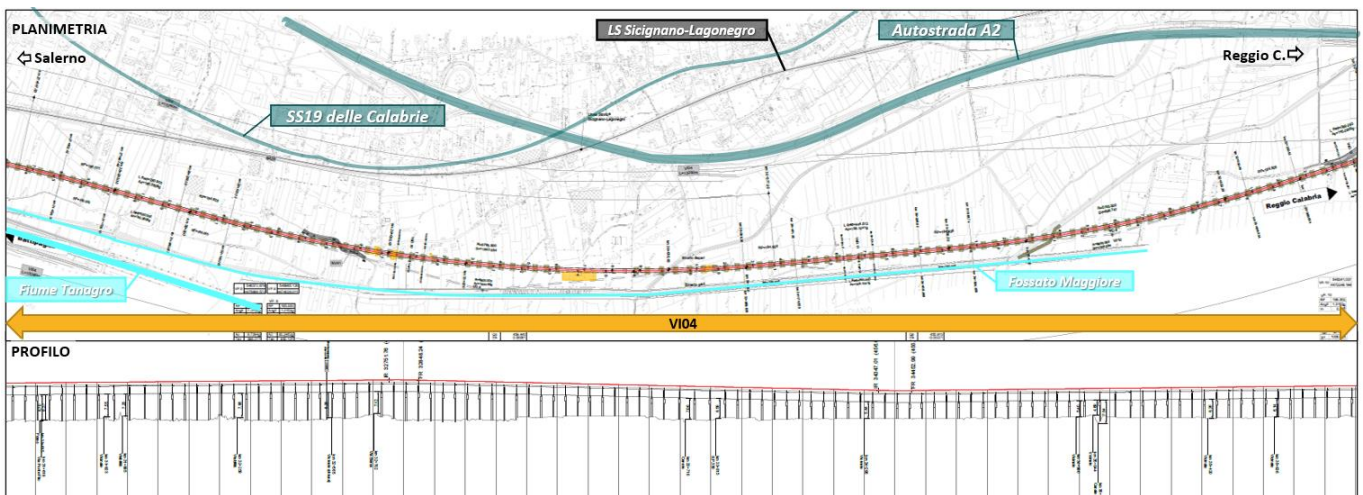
Planoprofilo di progetto da km 32+300 a km 35+100
